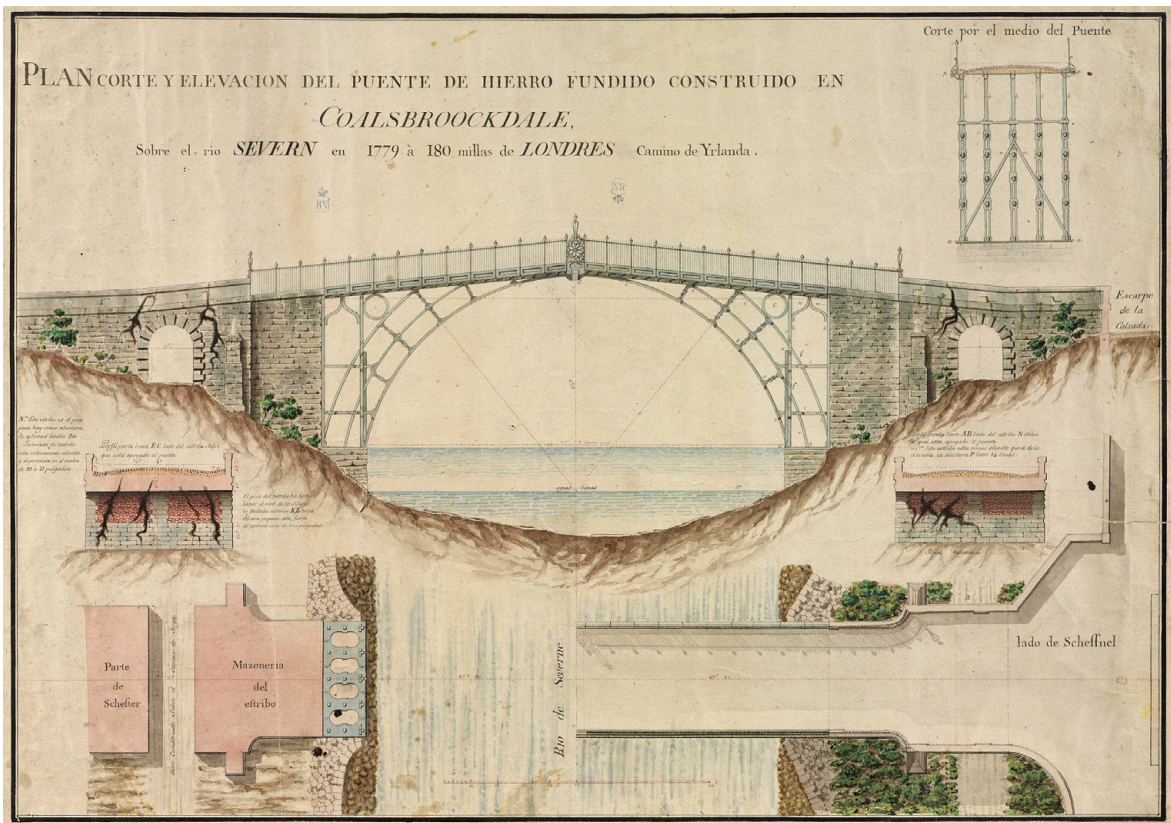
Plan, corte y elevación del puente de hierro fundido construido en Coalsbrookdale [sic]... en 1779..., Biblioteca Nacional de España, Dib/14/45/18.
